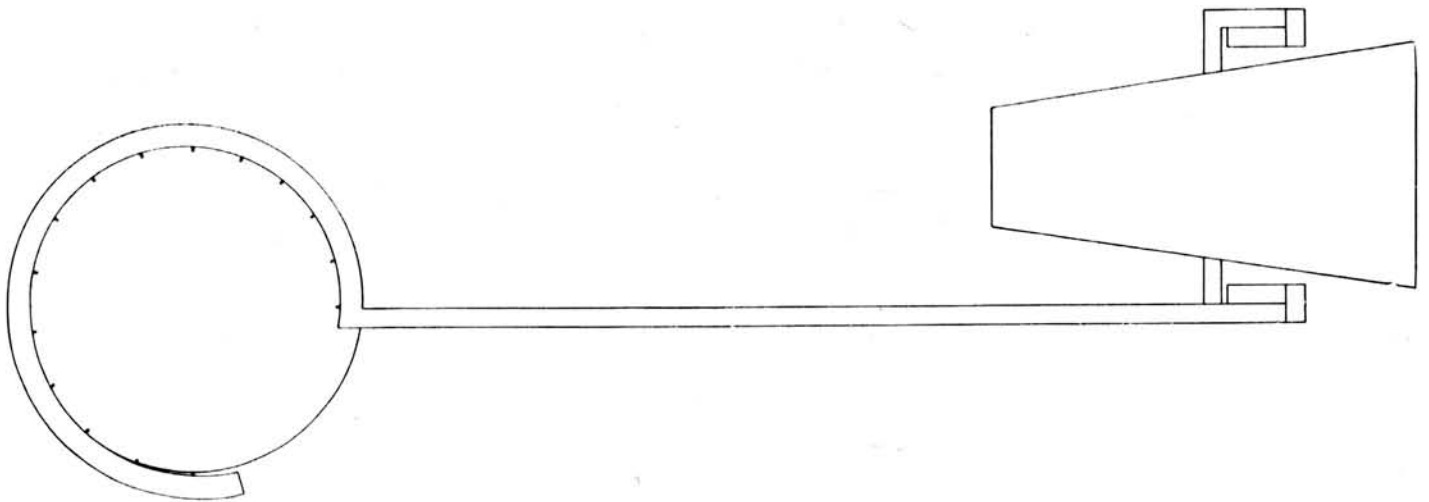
PLANTA BAIXA - COBERTURA - CONJUNTO PALÁCIO DAS ARTES/ AUDITÓRIO
